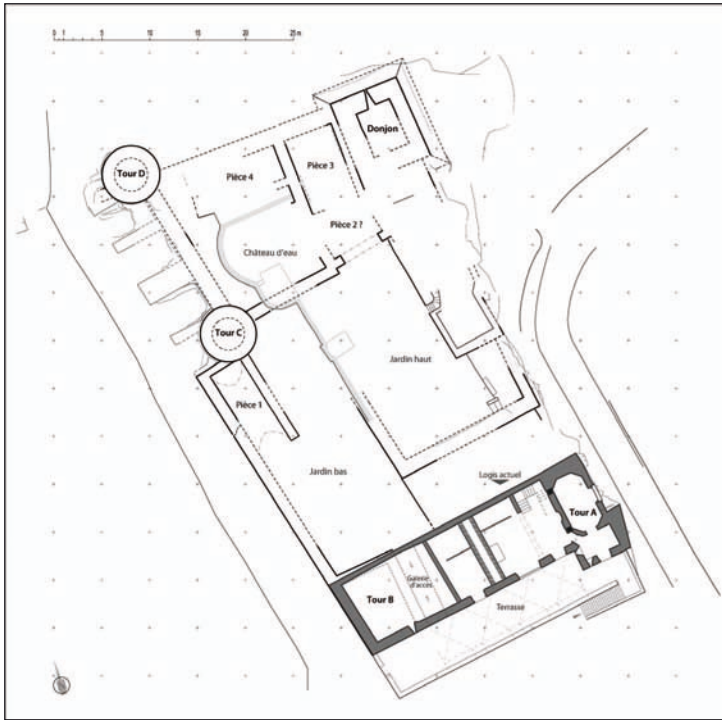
Plan général des constructions visibles aujourd'hui.
